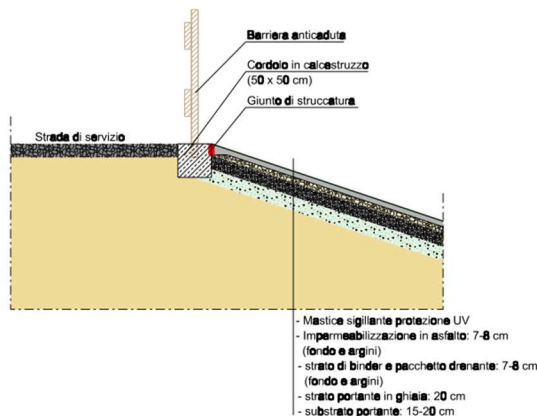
Dettaglio del sistema di impermeabilizzazione (estratto Tav. PD-EP.16.2).
